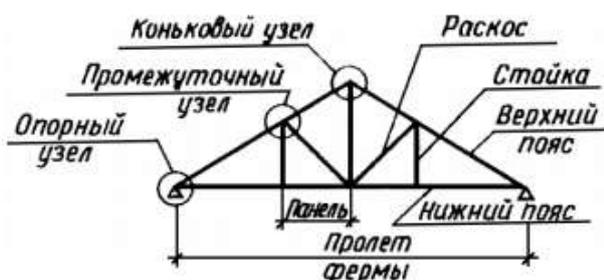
Геометрическая схема фермы. Элементы фермы
